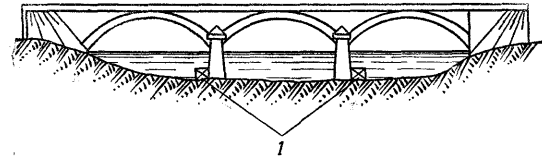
Подрывание низких опор арочных железобетонных мостов подводными зарядами;
